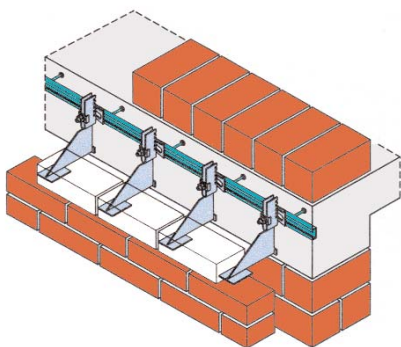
е Вариант конструкции наружной стены с опиранием лицевого слоя на стальные кронштейны [1.22]
